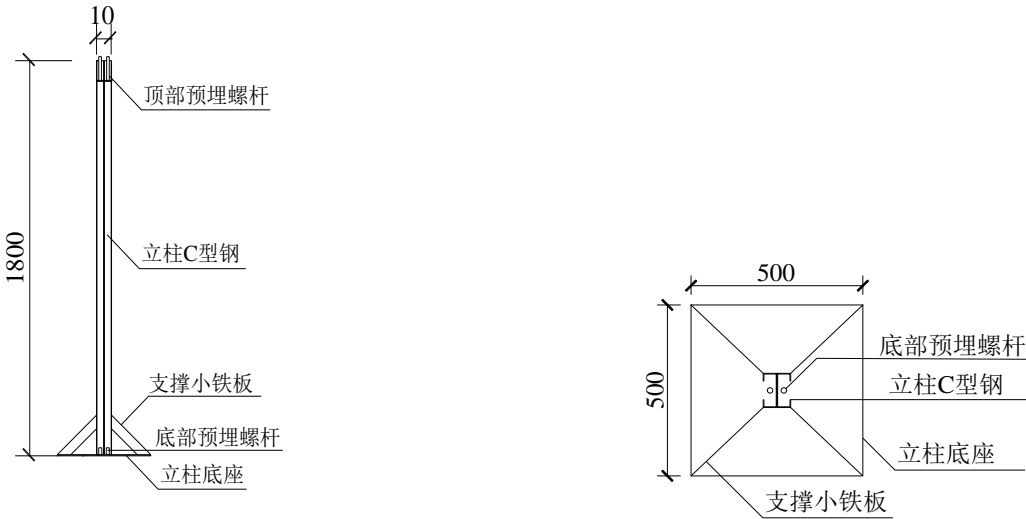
围蔽立柱剖面 A 示意图 (单位: mm) 图 C.0.3-3 立柱底座大样示意图 (单位: mm)
